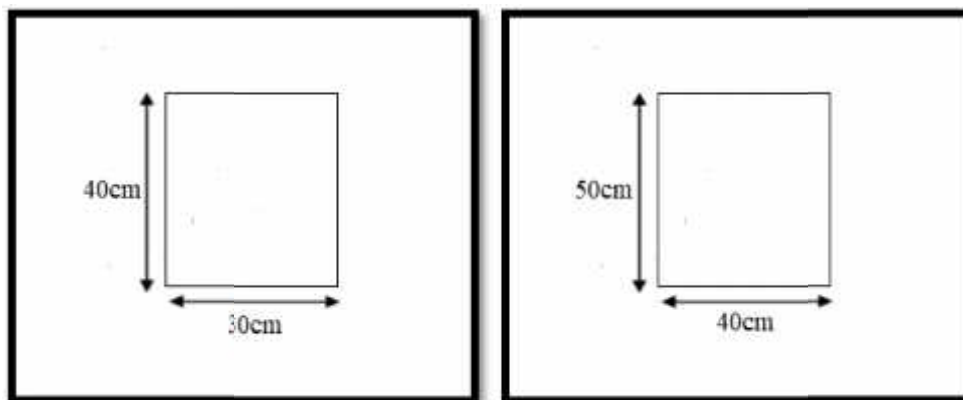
sections des poteaux : (50x40) et (40x30) cm<sup>2</sup>
